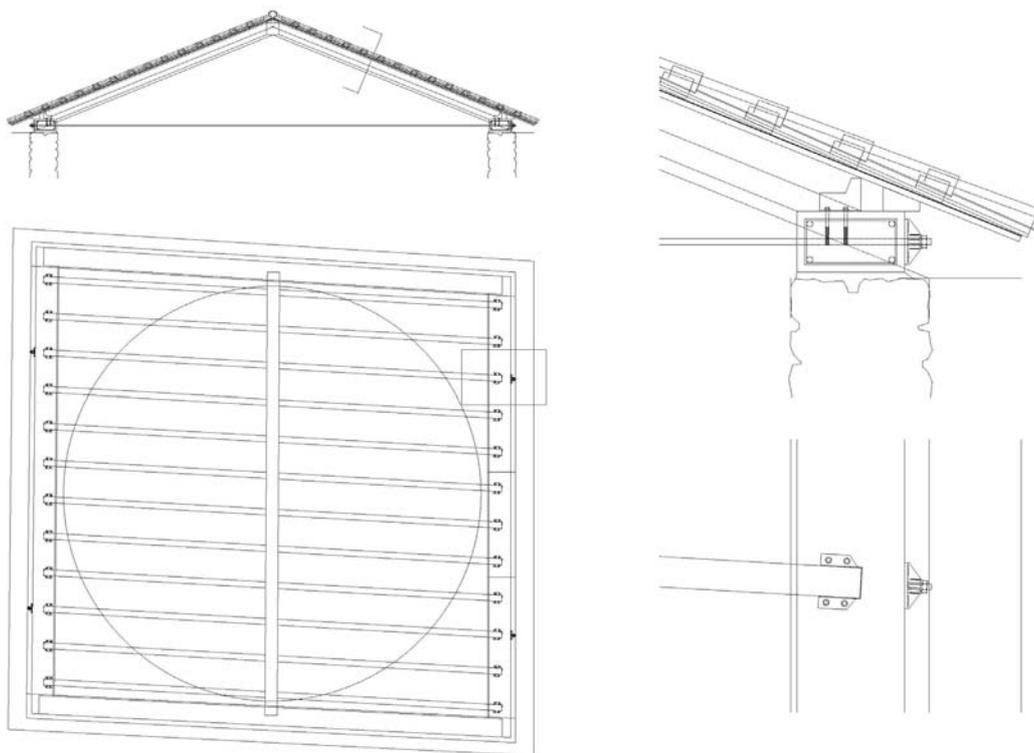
Planos del proyecto de restauración. Descripción de la cubierta.
